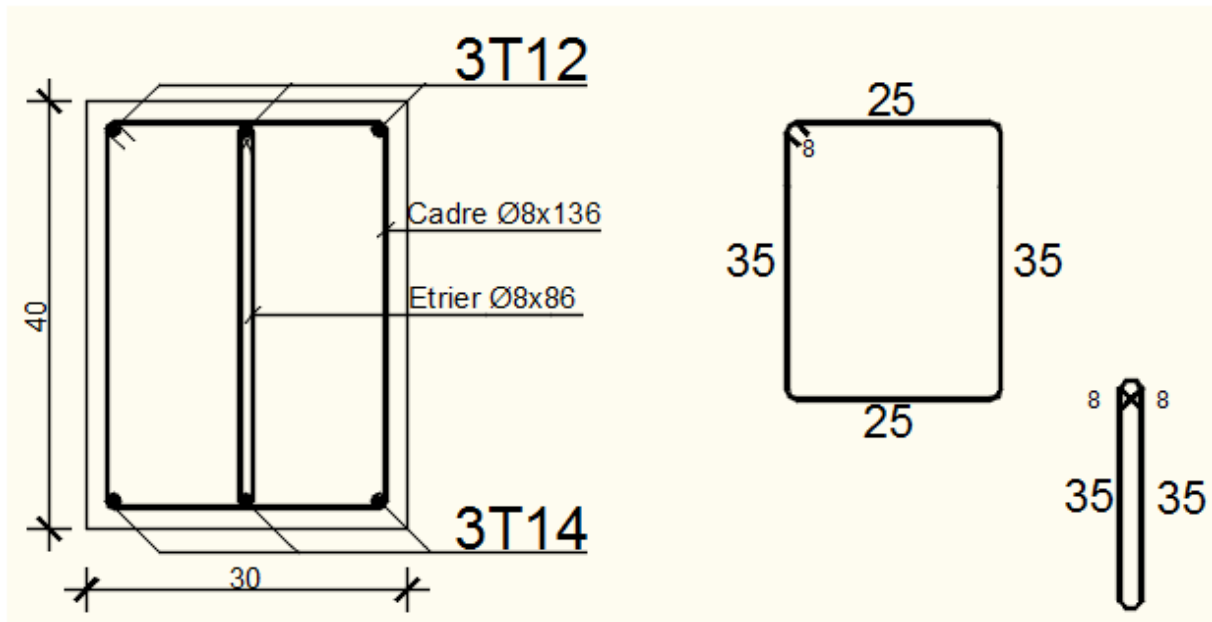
Dessin de ferrailage de la poutre palier en appuis.
